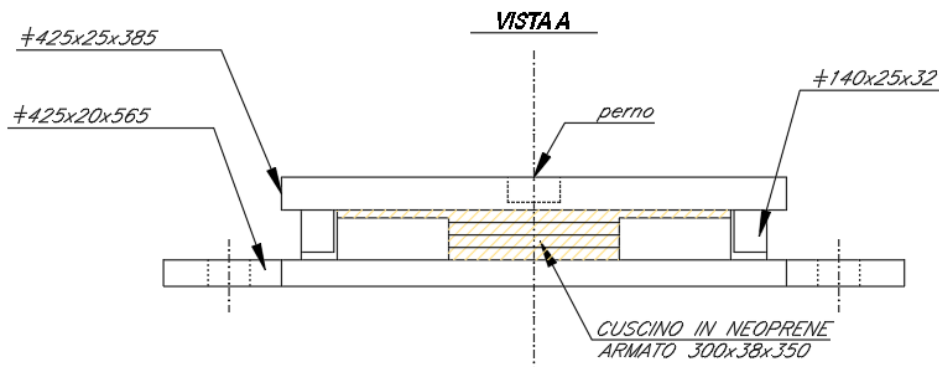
Dispositivi di appoggio unidirezionale – Sezione longitudinale
